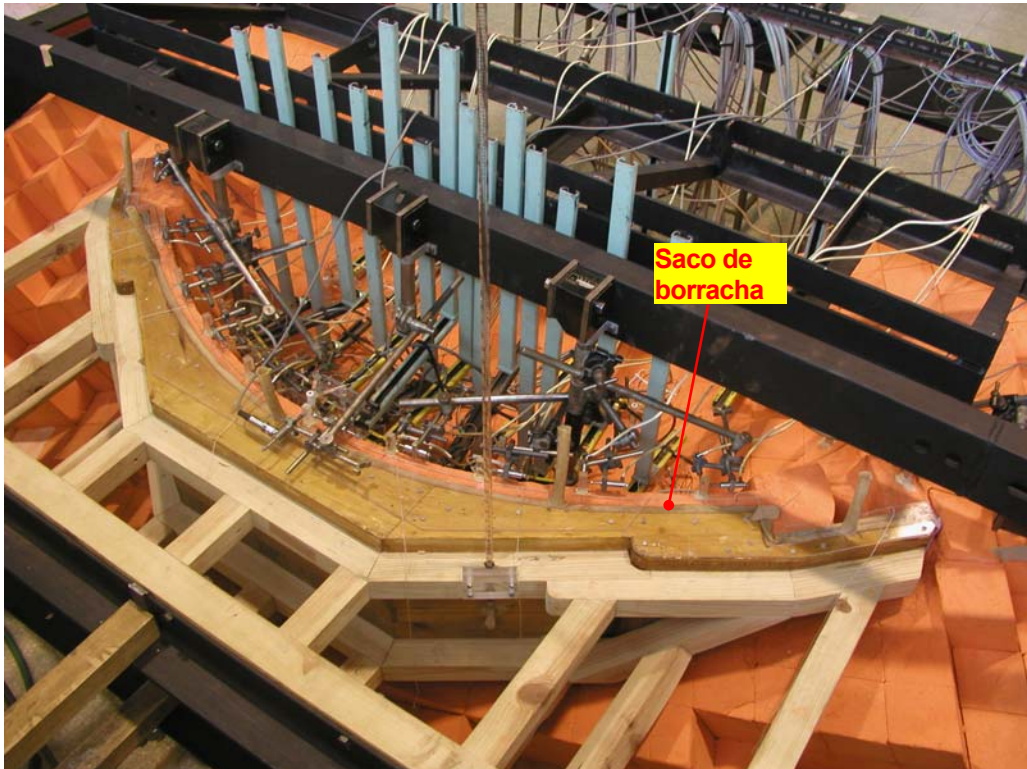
Pormenor do saco de borracha e da parede de reacção para aplicação da pressão hidrostática
